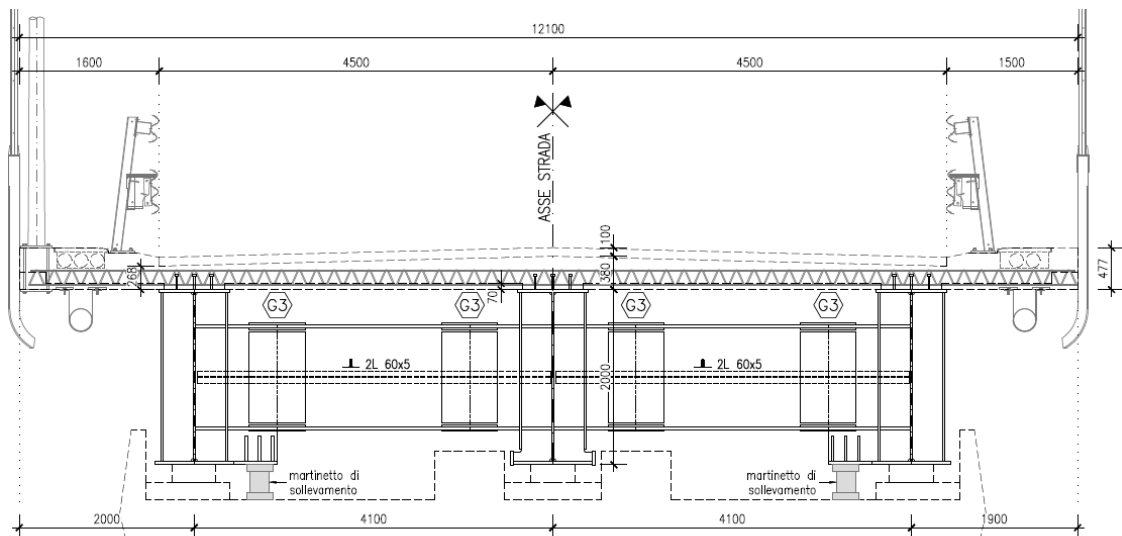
Sezione trasversale dell'impalcato in corrispondenza della pila
